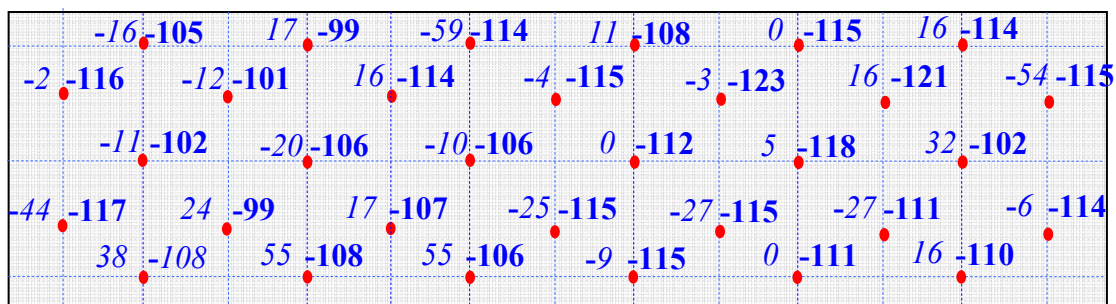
Potenciais de corrosão na face da viga V9.
